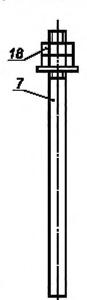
Типы и конструкция фундаментных болтов, лист 1
